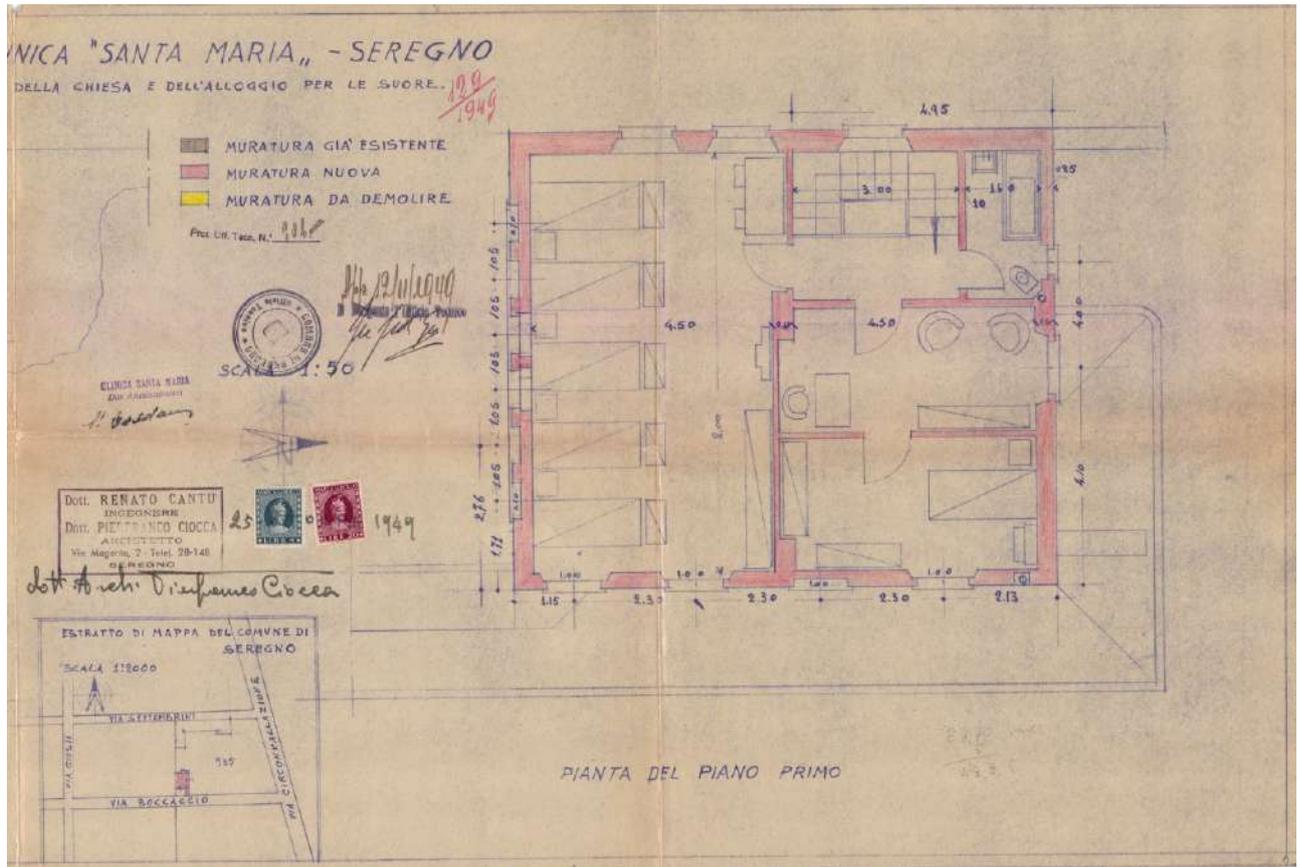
Pianta del Piano Primo, pratica edilizia 129/1949, Archivio Comune di Seregno.
